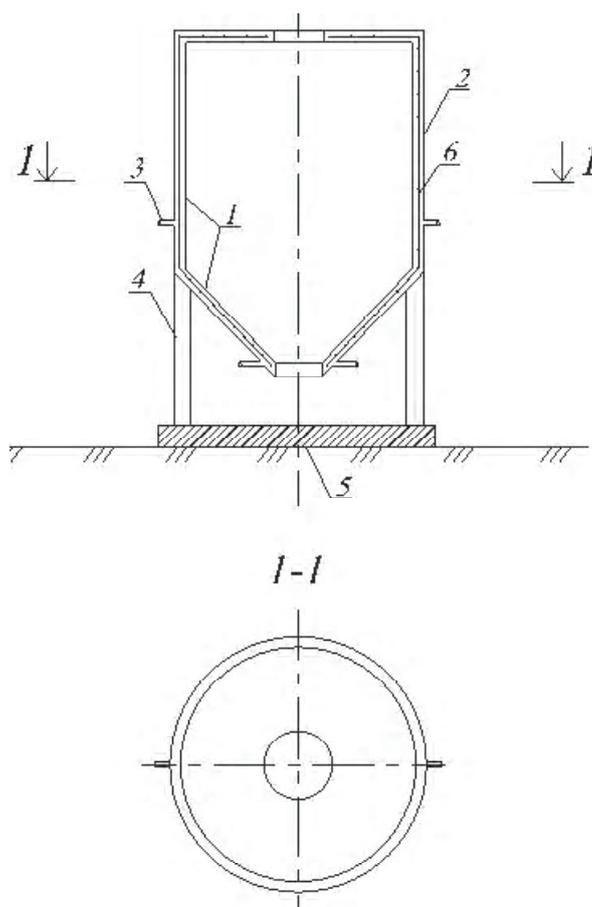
Монтаж опалубки бункера: 1 – внутренняя опалубка (футеровка); 2 – наружная опалубка; 3 – штуцеры для подачи бетона; 4 – колонны; 5 – фундамент; 6 – арматура.
